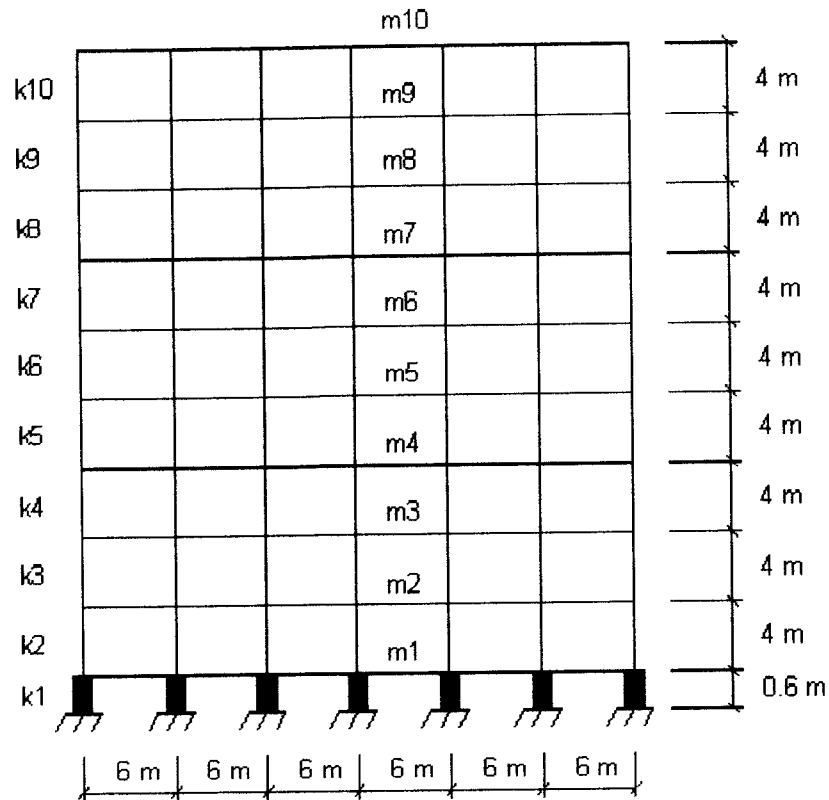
Pemodelan struktur beton bertingkat 10 tanpa *Base isolation
